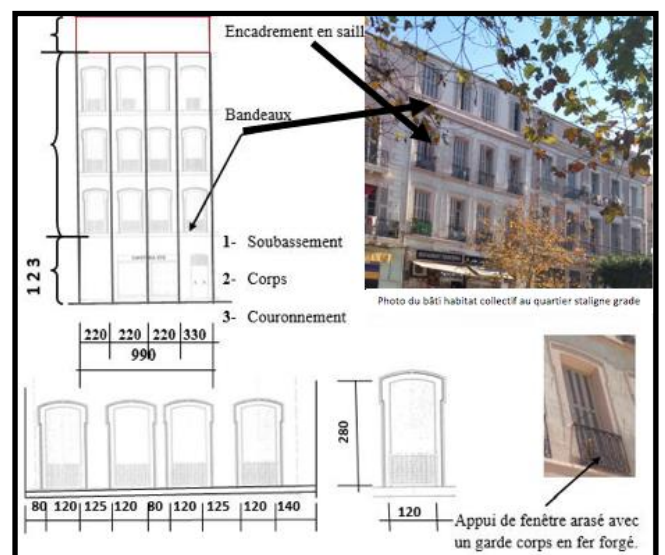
photo explicative de la façade de l'habitat du style colonial
